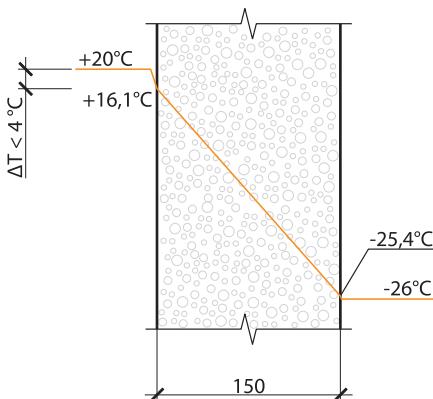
Стена из газобетона D400 толщиной 150 мм обеспечивает тепловой комфорт
